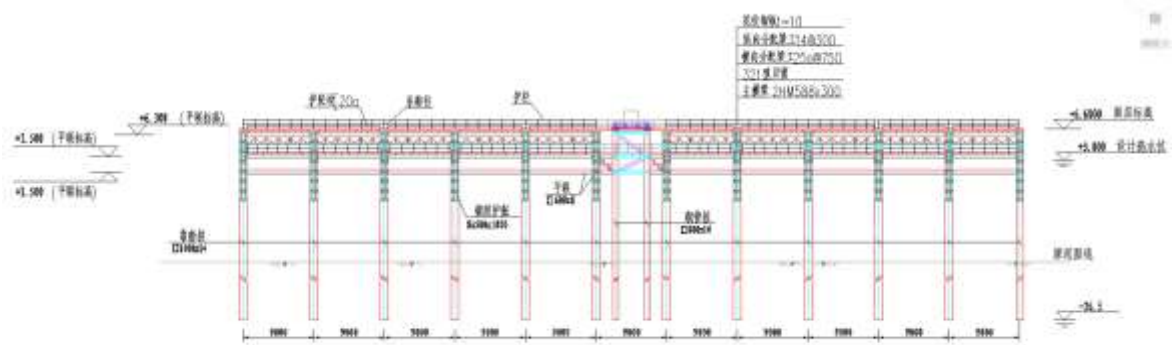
水上材料码头立面图（尺寸单位：mm）
